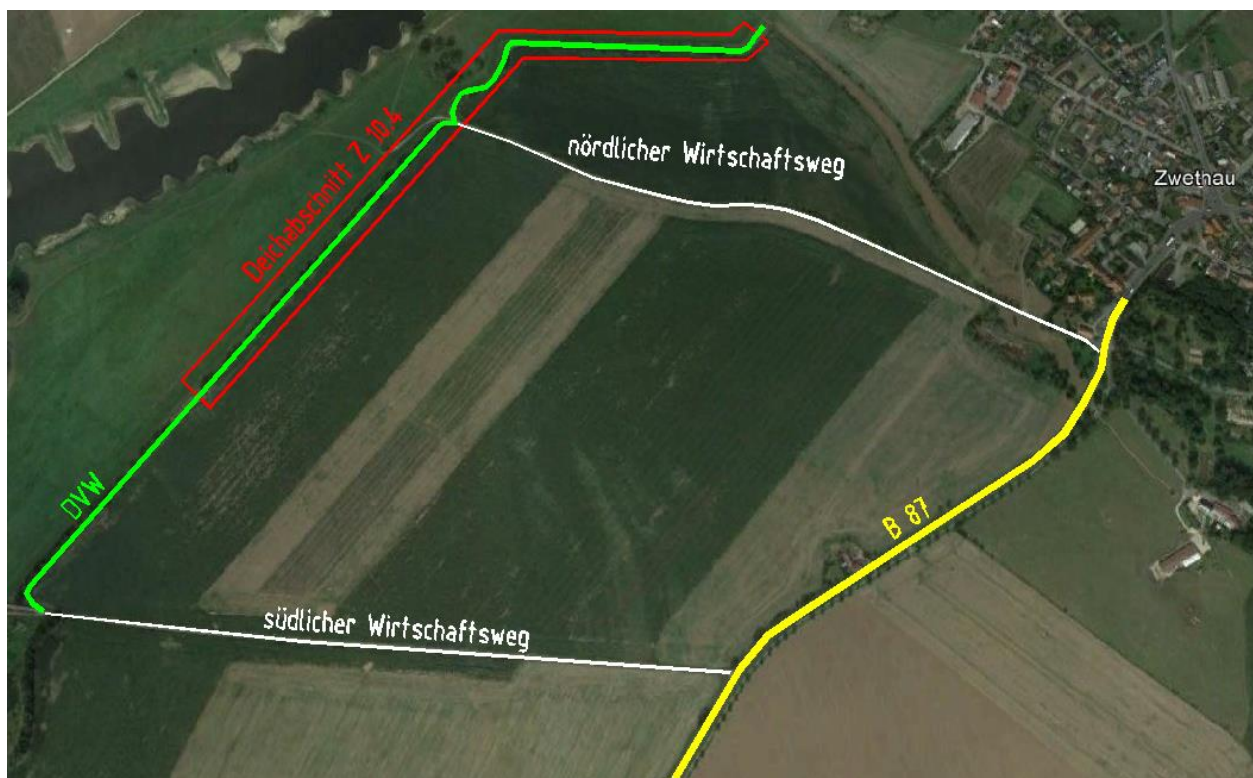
Baustellenzufahrt Deichabschnitt Z 10.4
